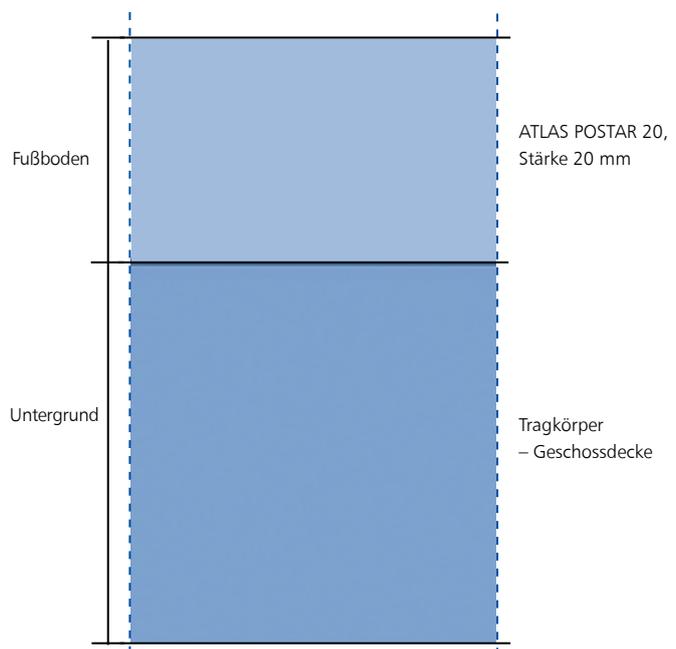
Mit dem Untergrund verbundener Estrich – Aufbau.
